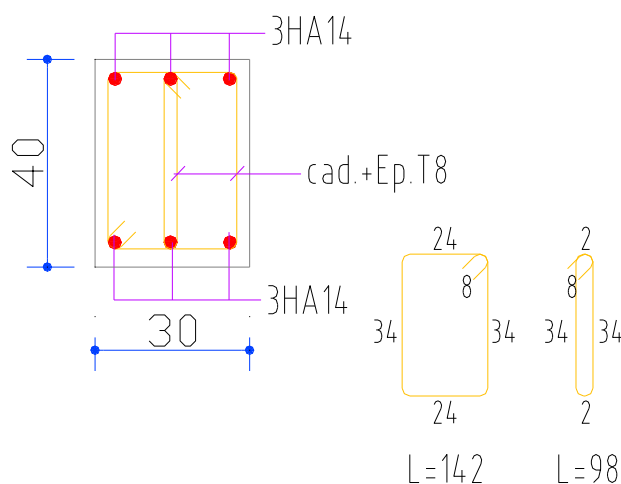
Ferrailage des poutres principales au niveau de travée de niveaux sous-sol, RDC et terrasse.
